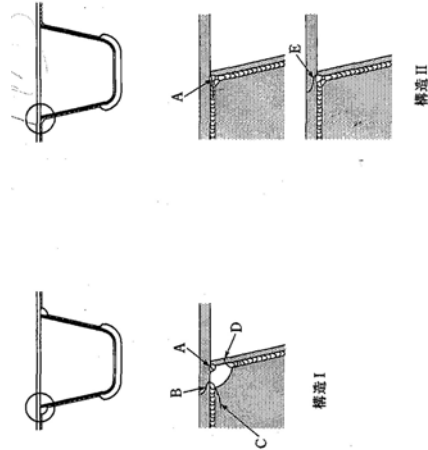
デッキプレート側スカラップ部の主な疲労き裂発生箇所
